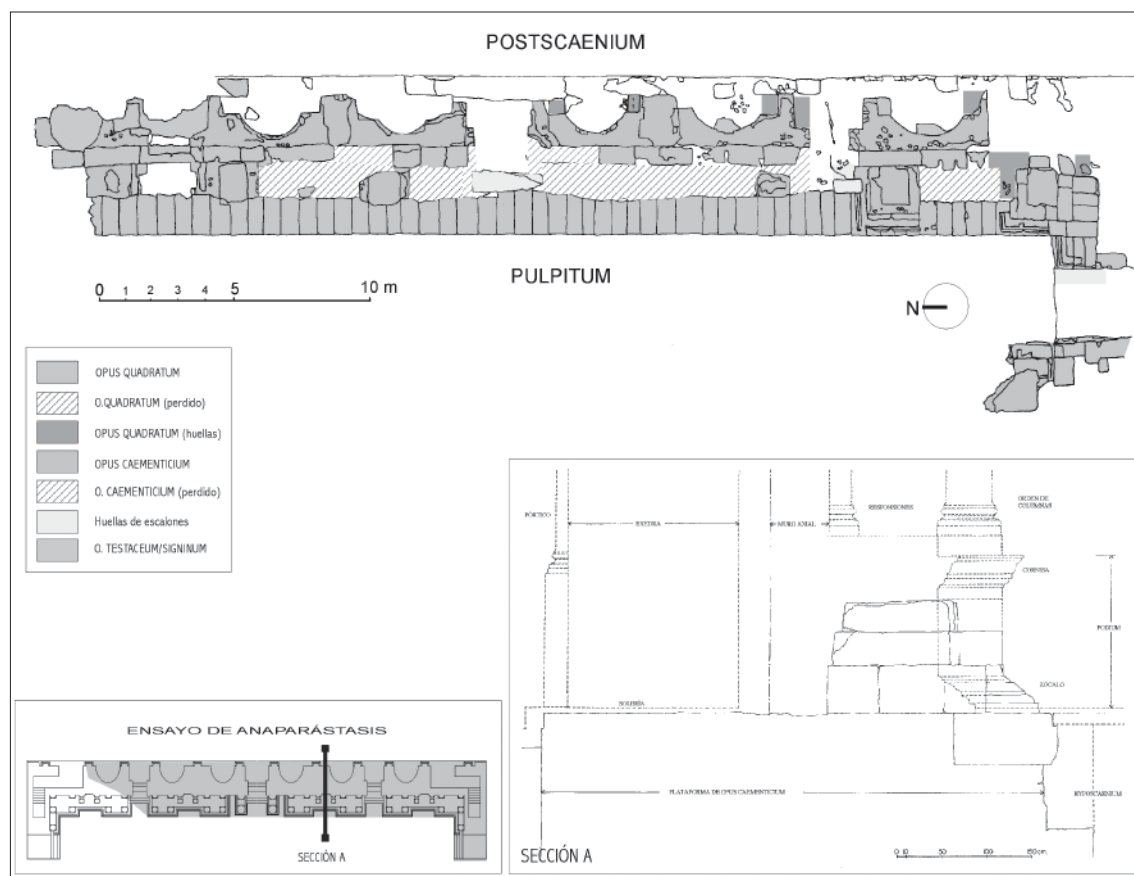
Planta y sección de las fábricas que componían el edificio escénico.
